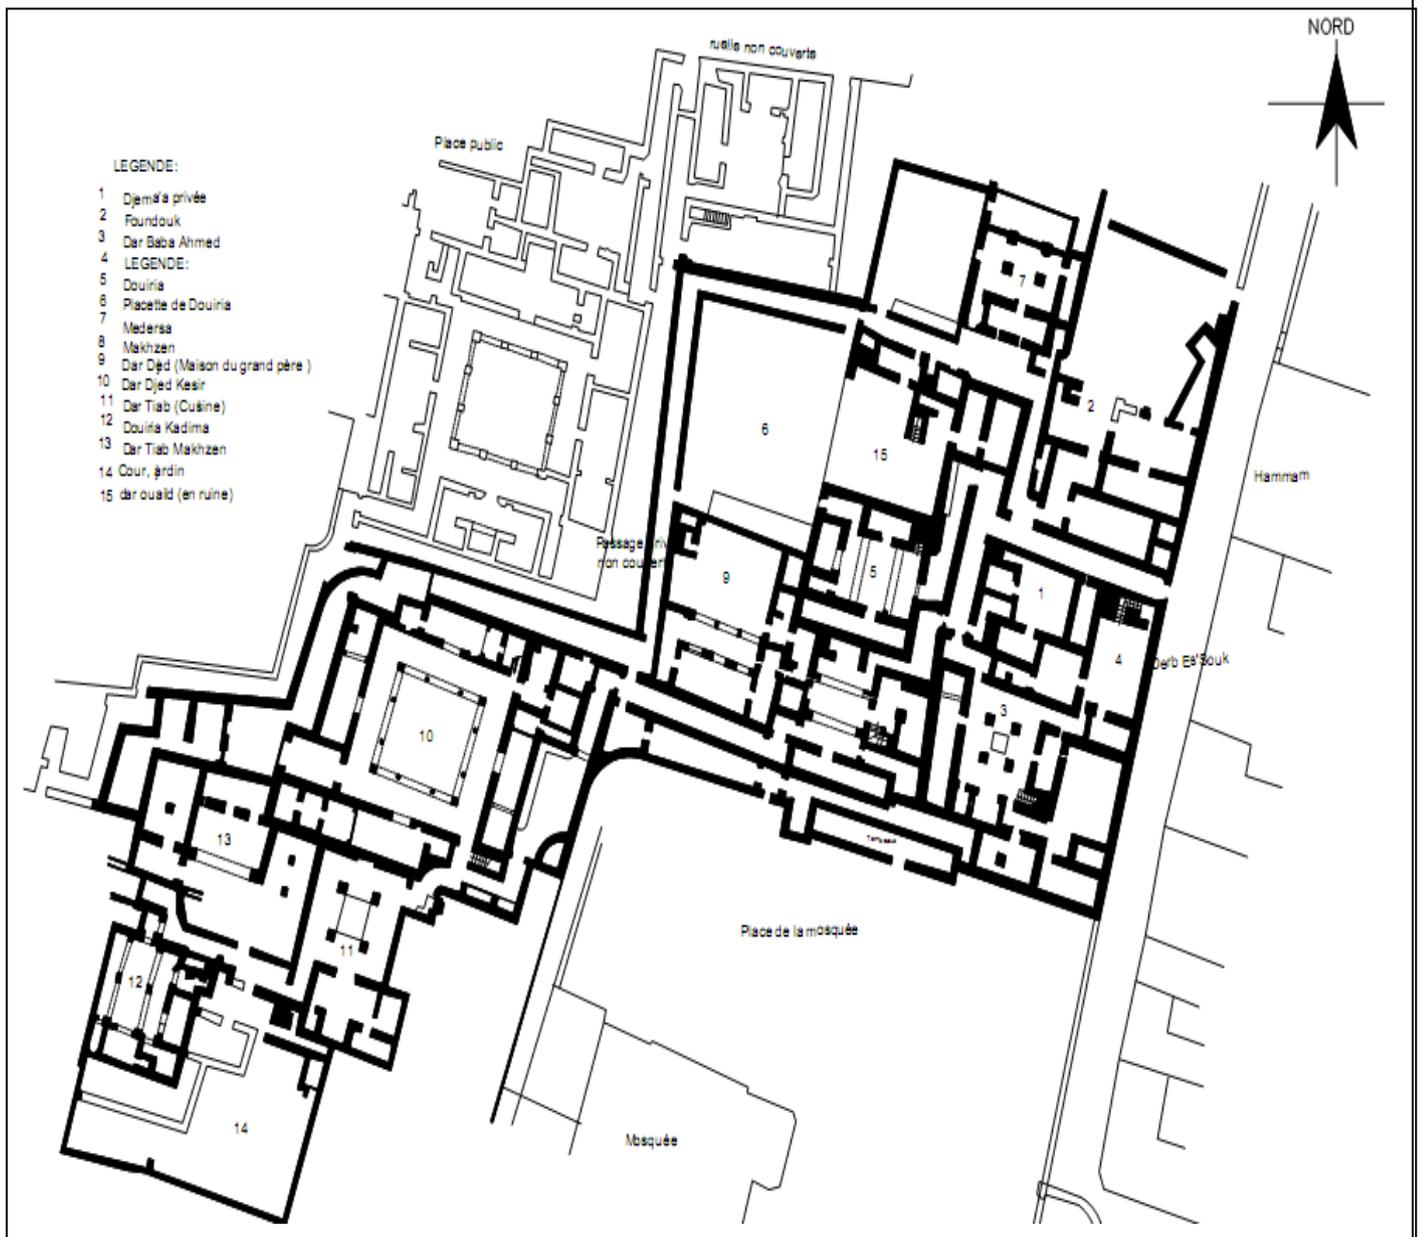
Plan du rez-de-chaussée de la maison familiale (*Dar*).
